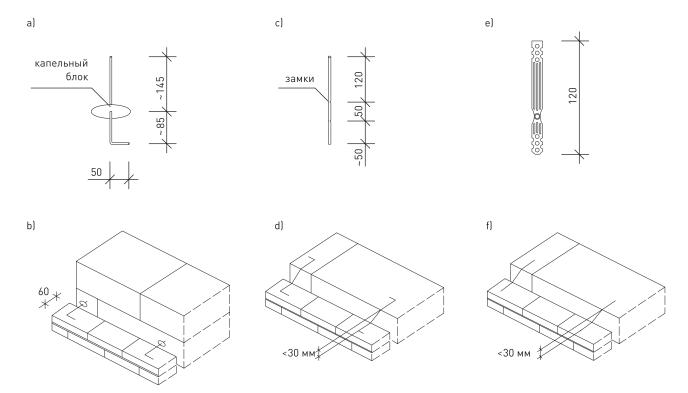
Соединения слоев двухслойной стены с воздушной прослойкой при помощи анкеров.
